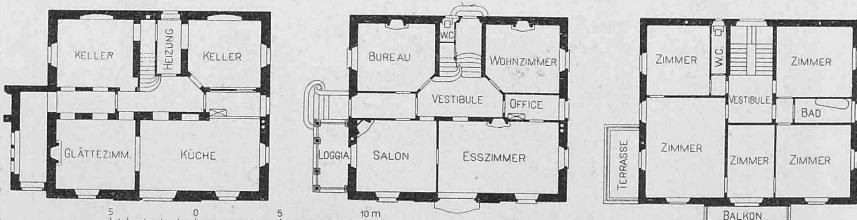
Grundrisse vom Keller-, Erd- und Obergeschoß der Villa Soldati in Neggio. — 1 : 400.
